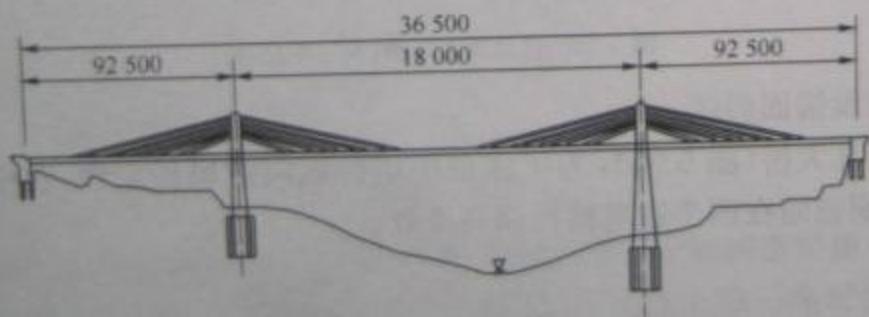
日见桥总体布置示意图(尺寸单位:cm)
